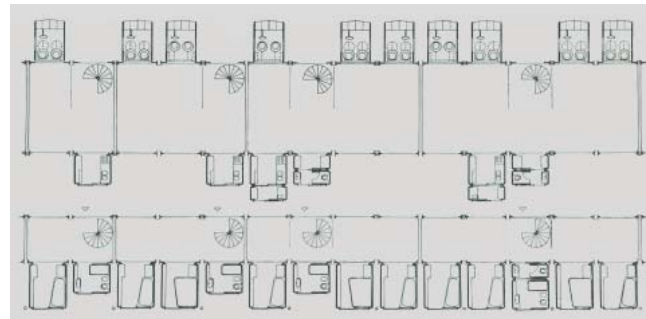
Planta d'un edifici compostat de Mobile houses.
